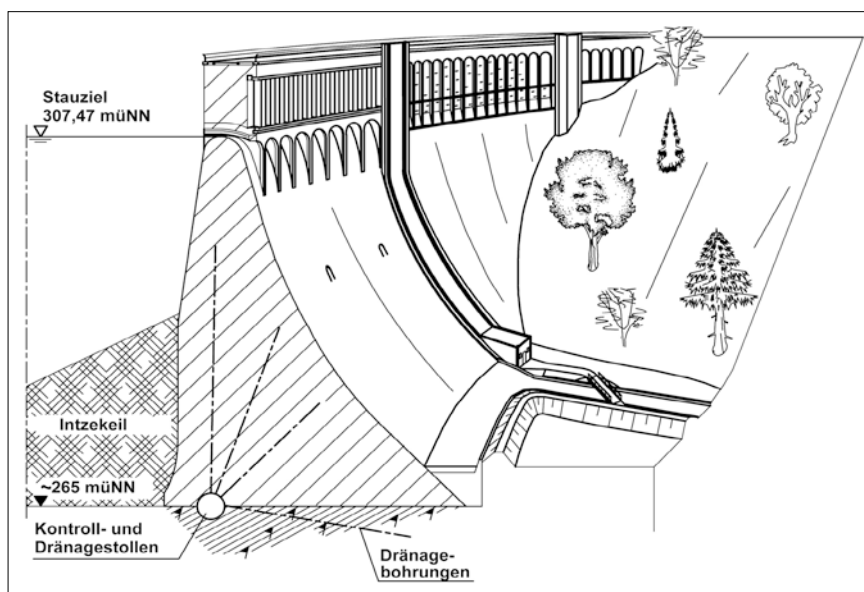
Querschnitt Ennepestaumauer mit Kontrollstollen und Drainagebohrungen
